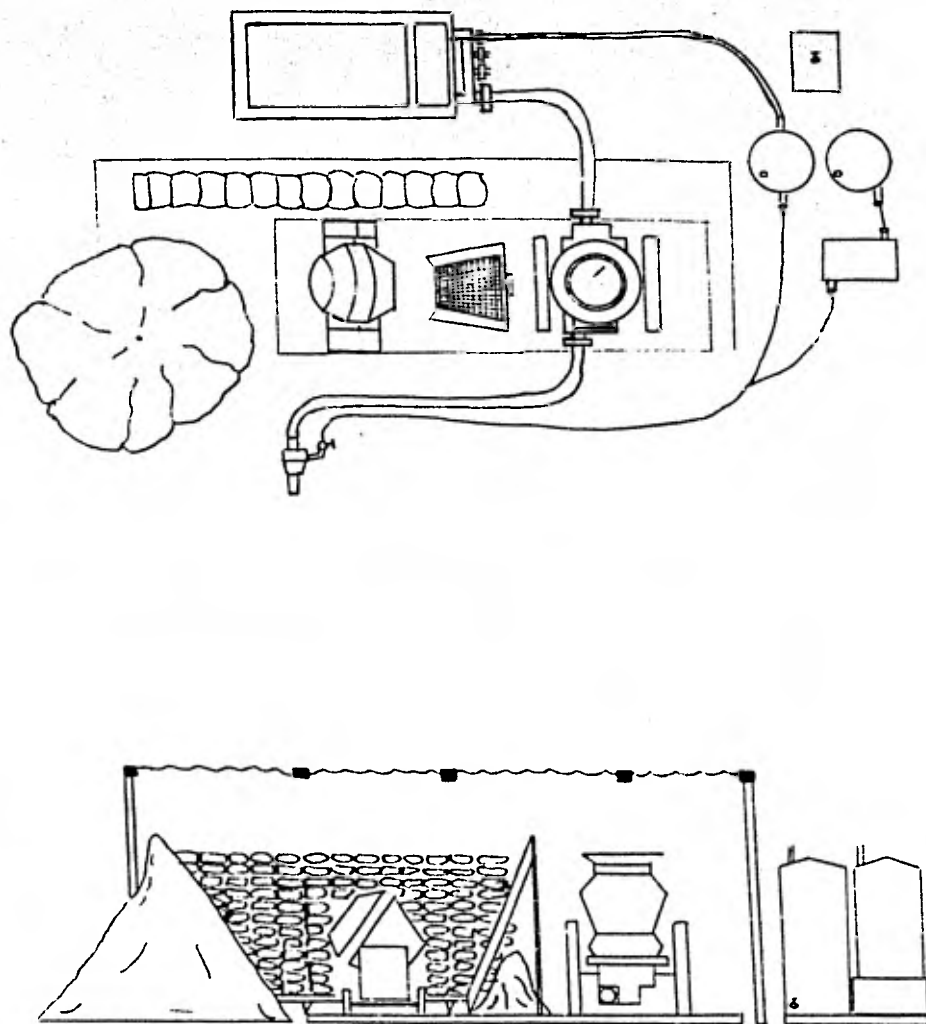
Distribución de una planta para concreto lanzado .
